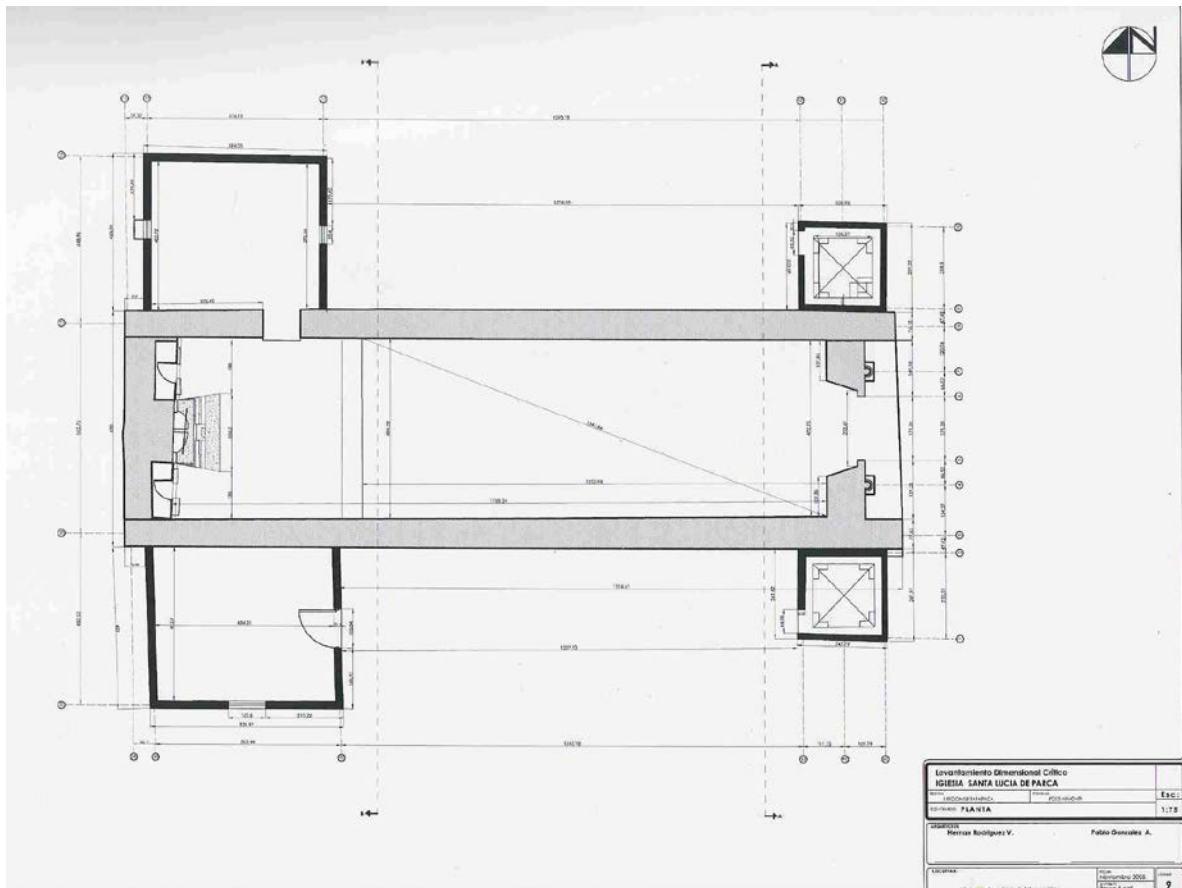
Planta de levantamiento de arquitectura. Arquitectos H. Rodríguez y P. González, 2005
